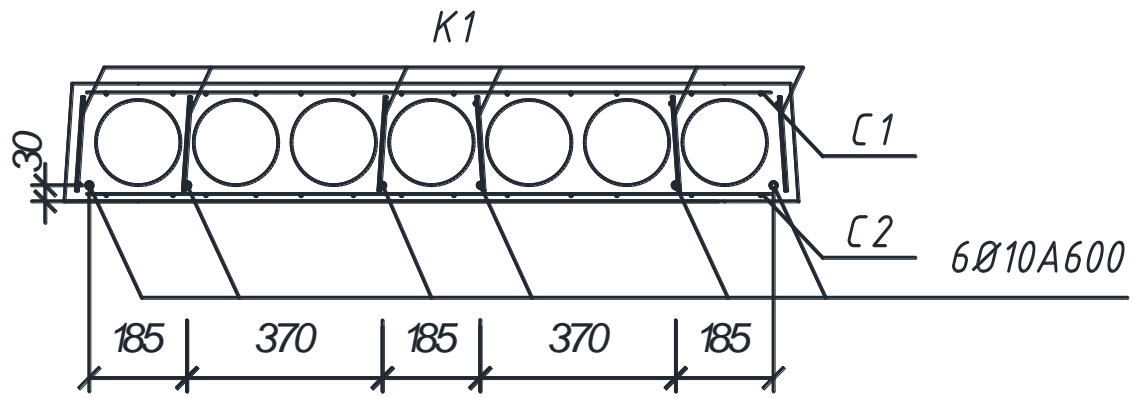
Схема продольного и поперечного армирования плиты
